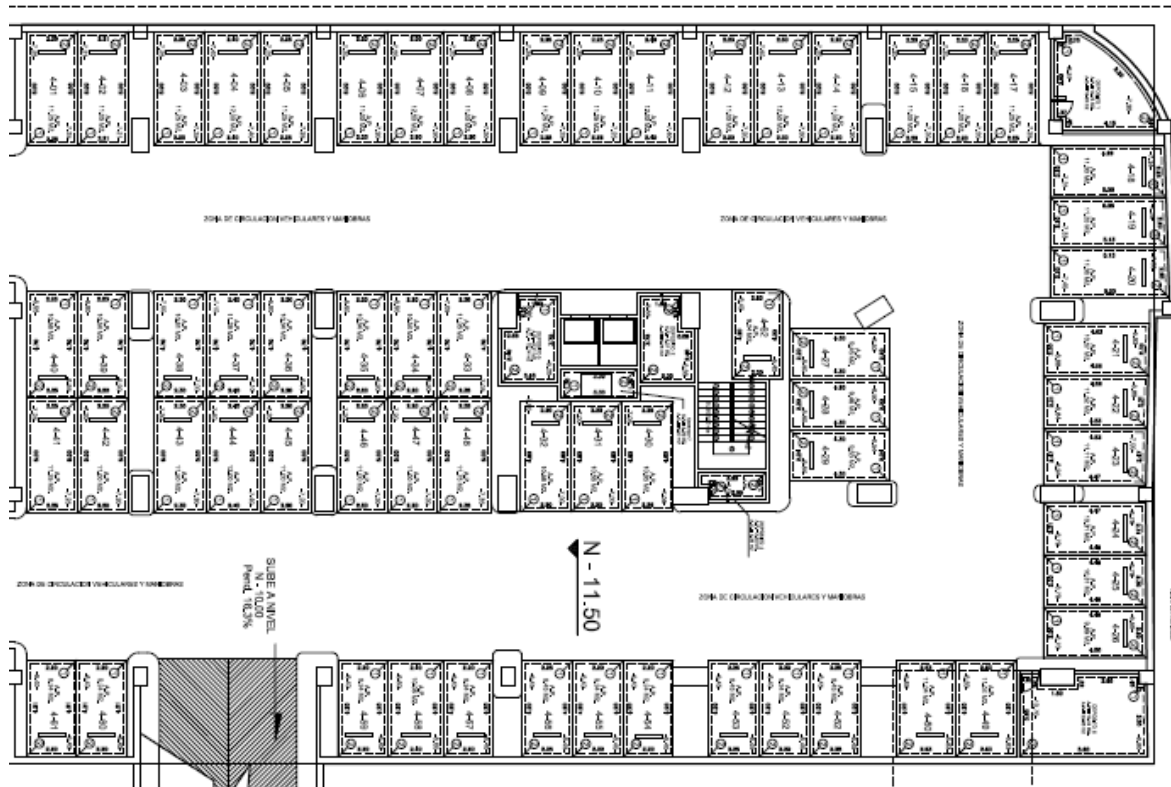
Planta Arquitectónica Nivel de sótano N-11.50
